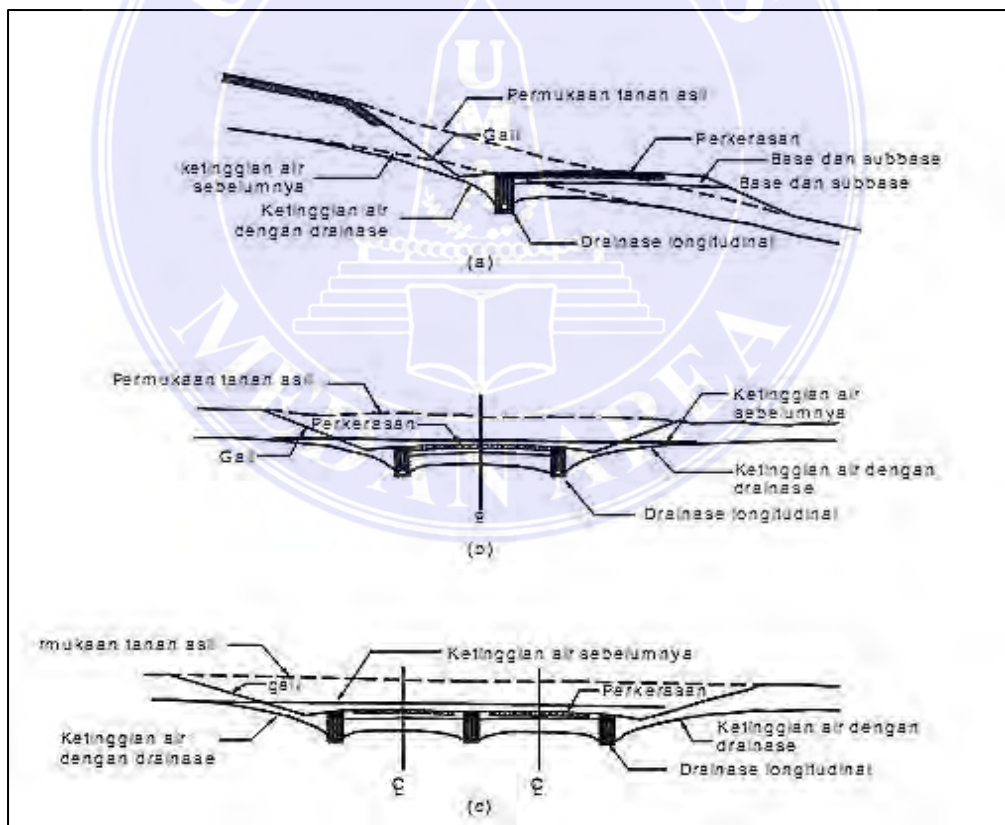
Tipikal Drainase Untuk Muka Air Rendah
